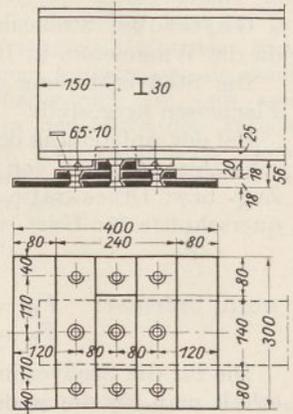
Lagerplatte aus mehreren Flacheisen.
